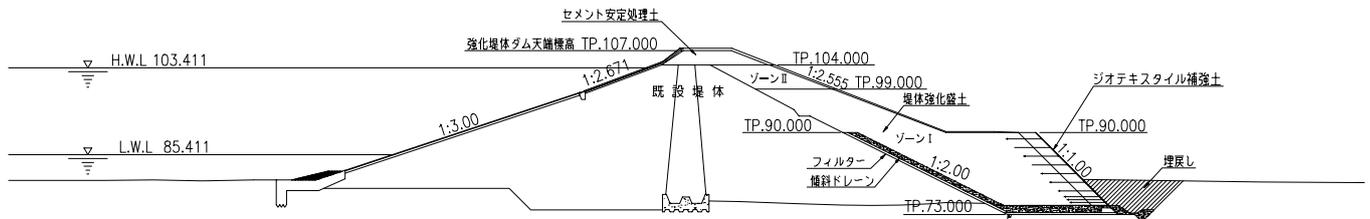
村山下貯水池堤体強化工事計画断面図（河床部標準断面図）
